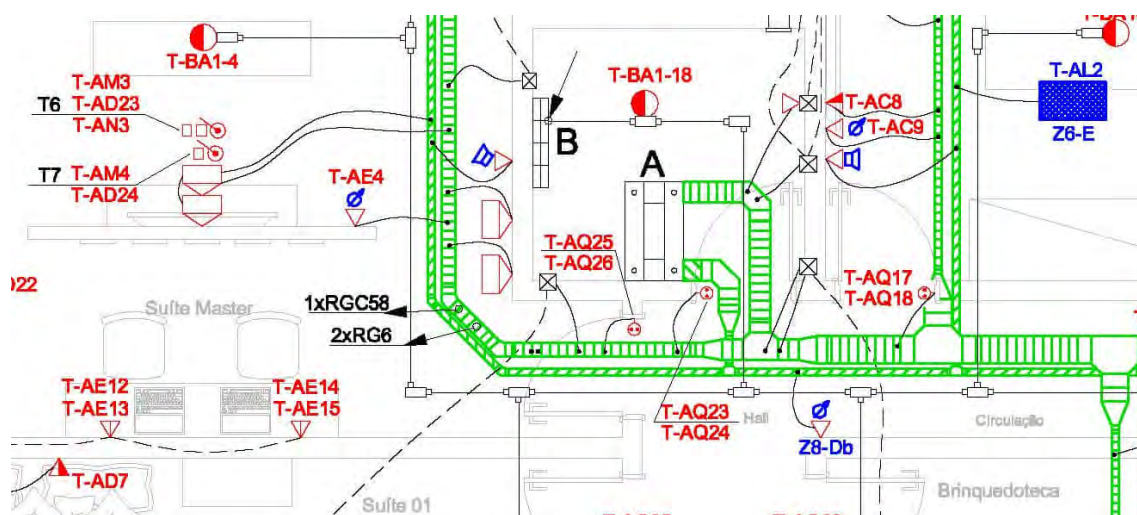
planta cabeamento: rack, eletrocalhas, terminações
